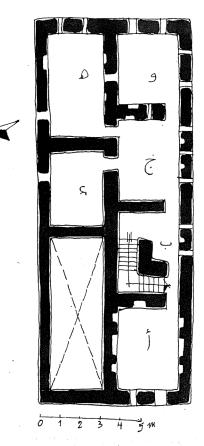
منزل الشريف أحمد الدور الأول مسقط أفقى "نقلا عن على لبيب محمد" "مرجع سابق"
